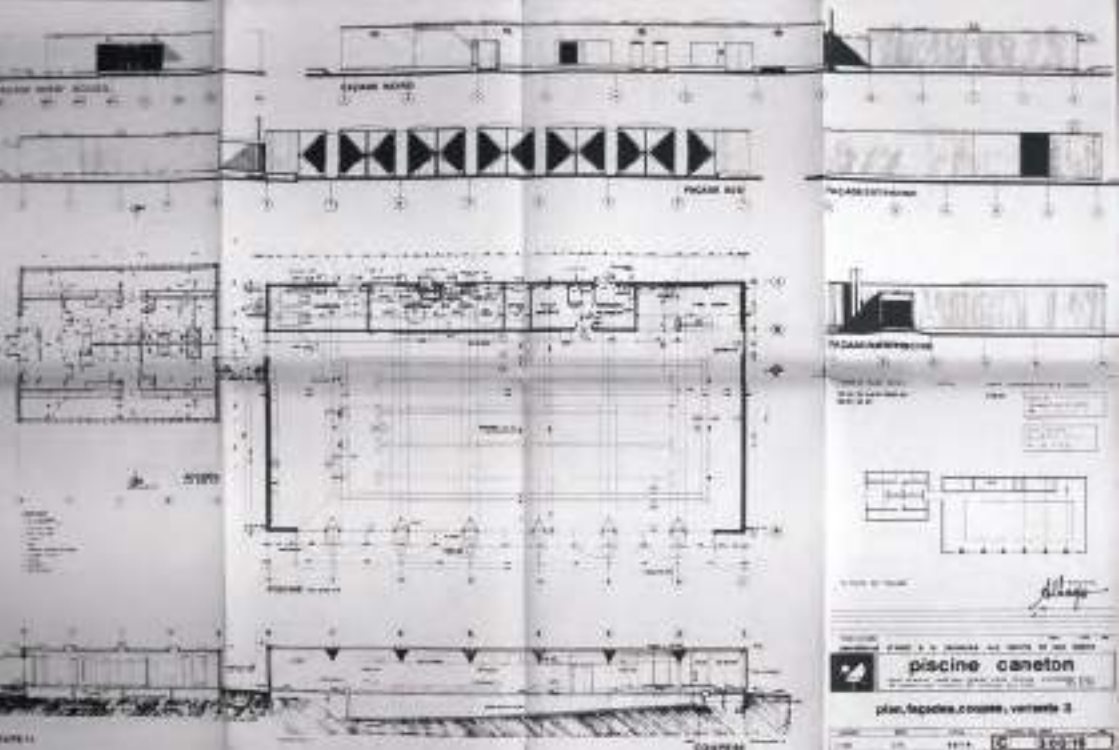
Plans, coupes et façades de la piscine Caneton du Fango, Architectes : Alain Charvier, Jean-Paul Aigrot, Franc Charras
